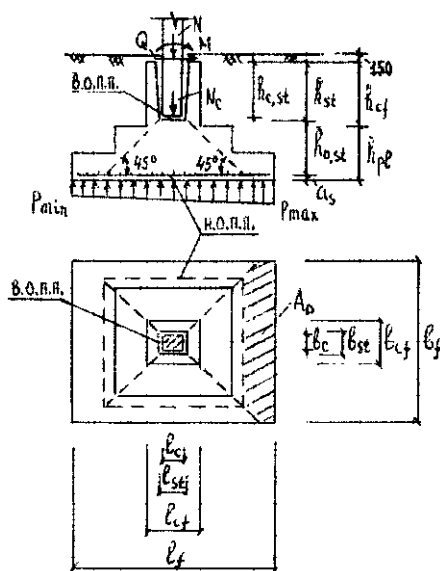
Схема образования пирамиды продавливания при стаканном сопряжении сборной железобетонной колонны с низким подколонником
